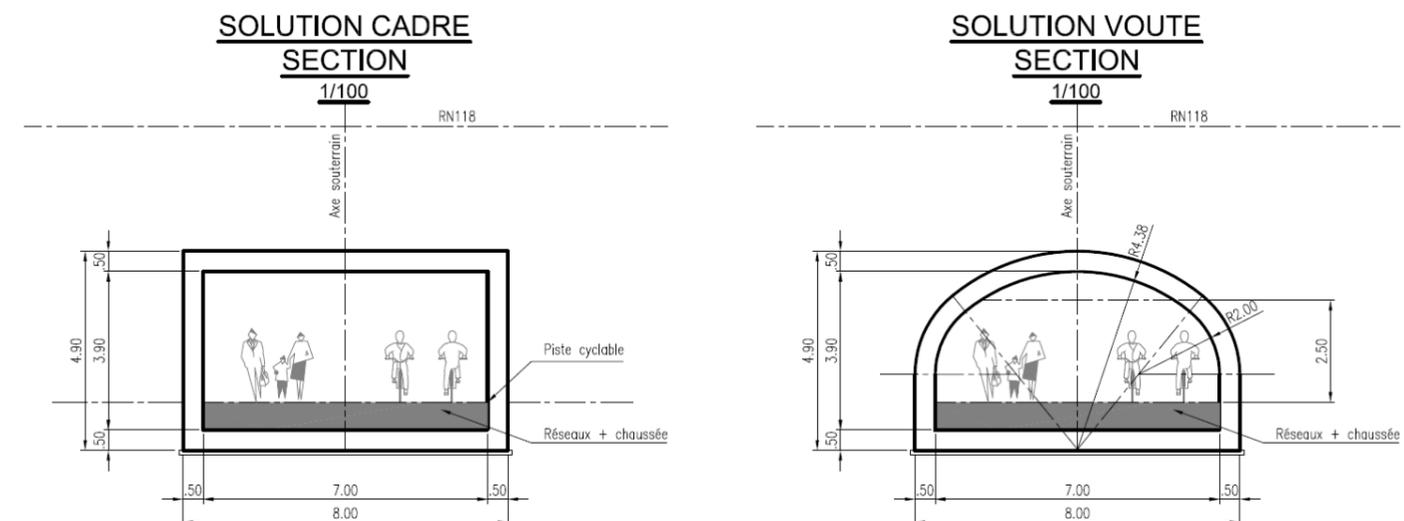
coupe ouvrage section 7 mètres : solution cadre et solution voûte
